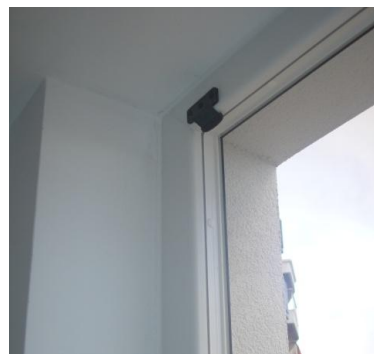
Pormenor construtivo dos envidraçados com protecção interior, Guarda
